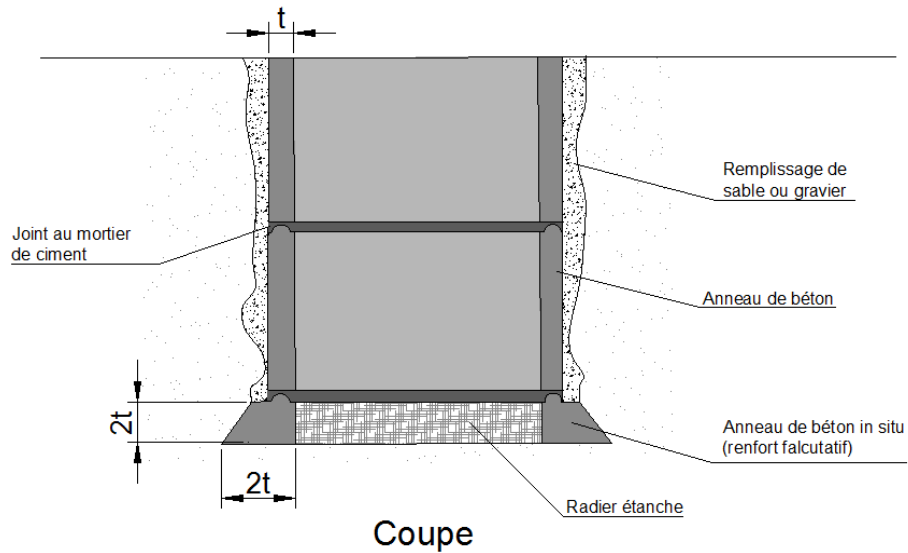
Fond de fosse avec revêtement d'anneaux préfabriqués en béton
